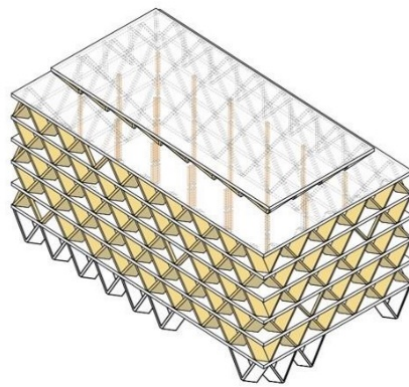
Tragelemente an der Fassade, im EG aus Beton, in den OGs aus Holz
